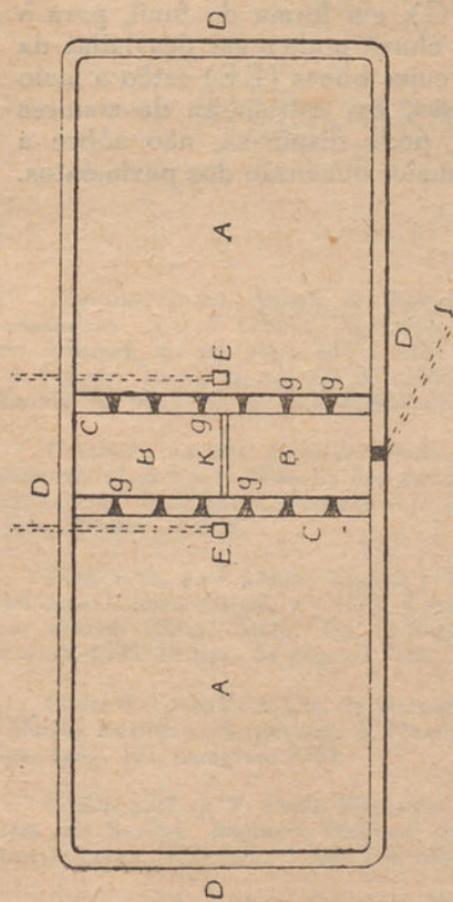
Estrumeira de fossa inclusa e dois pavimentos — Planta
